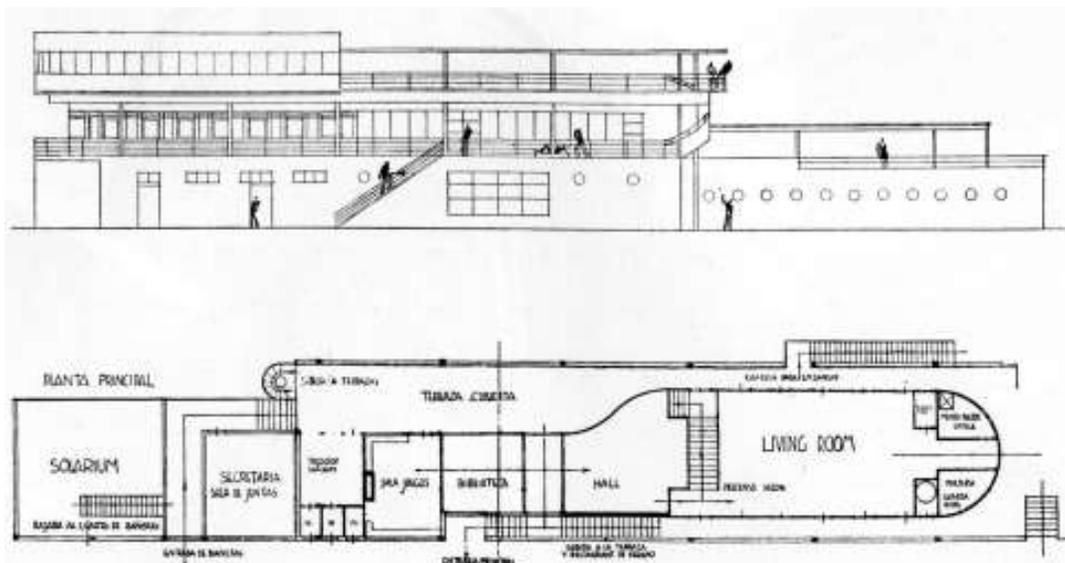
Elevación sur y planta principal del Real Club Náutico. San Sebastián, España. (1929). José Manuel Aizpúrua y Joaquín Labayen.
